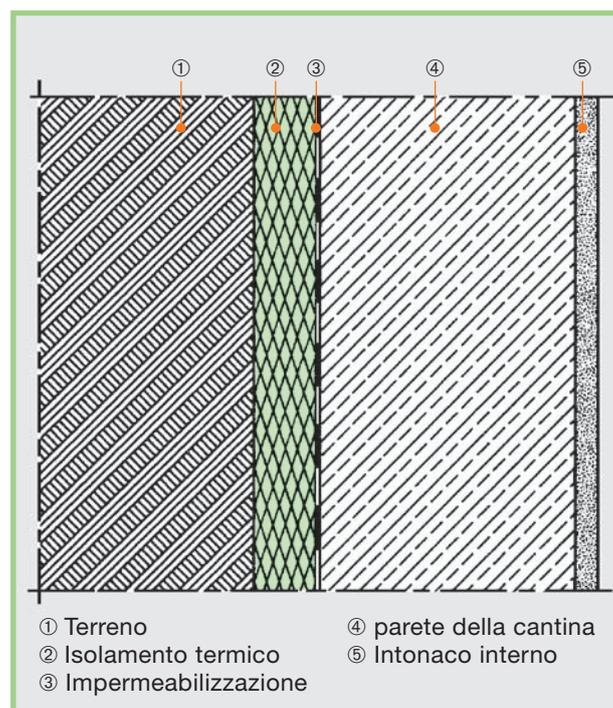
Parete di cantina con strato termoisolante esterno, a contatto con il terreno.
